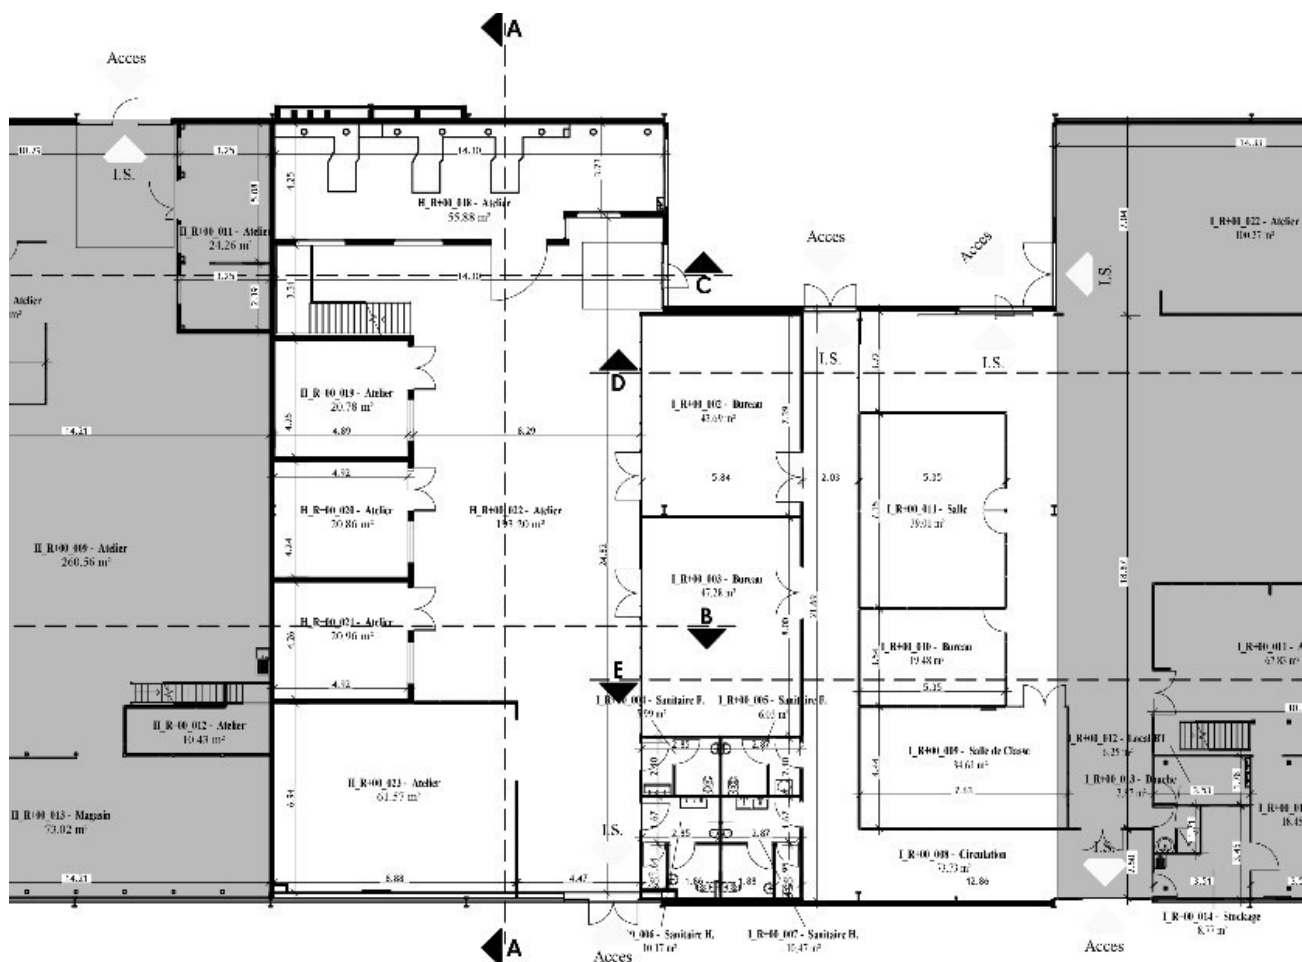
Plan de rez-de-chaussée des locaux actuels
